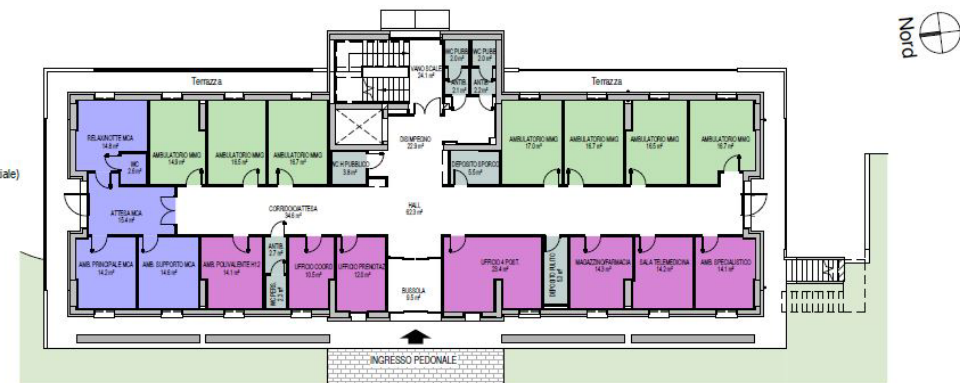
Pianta Piano Terra - Ipotesi di Progetto
